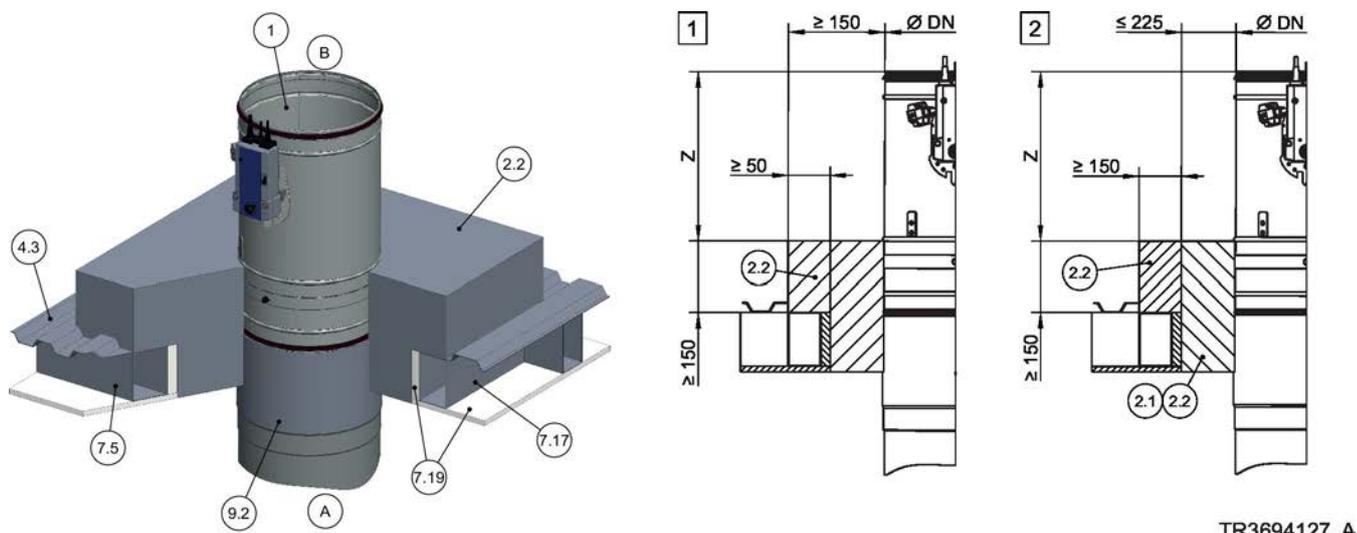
Montagem em argamassa em laje de teto maciça em combinação com tetos leves (sistema Cadolto), apresentado em pé (também aplicável para disposição suspensa)
